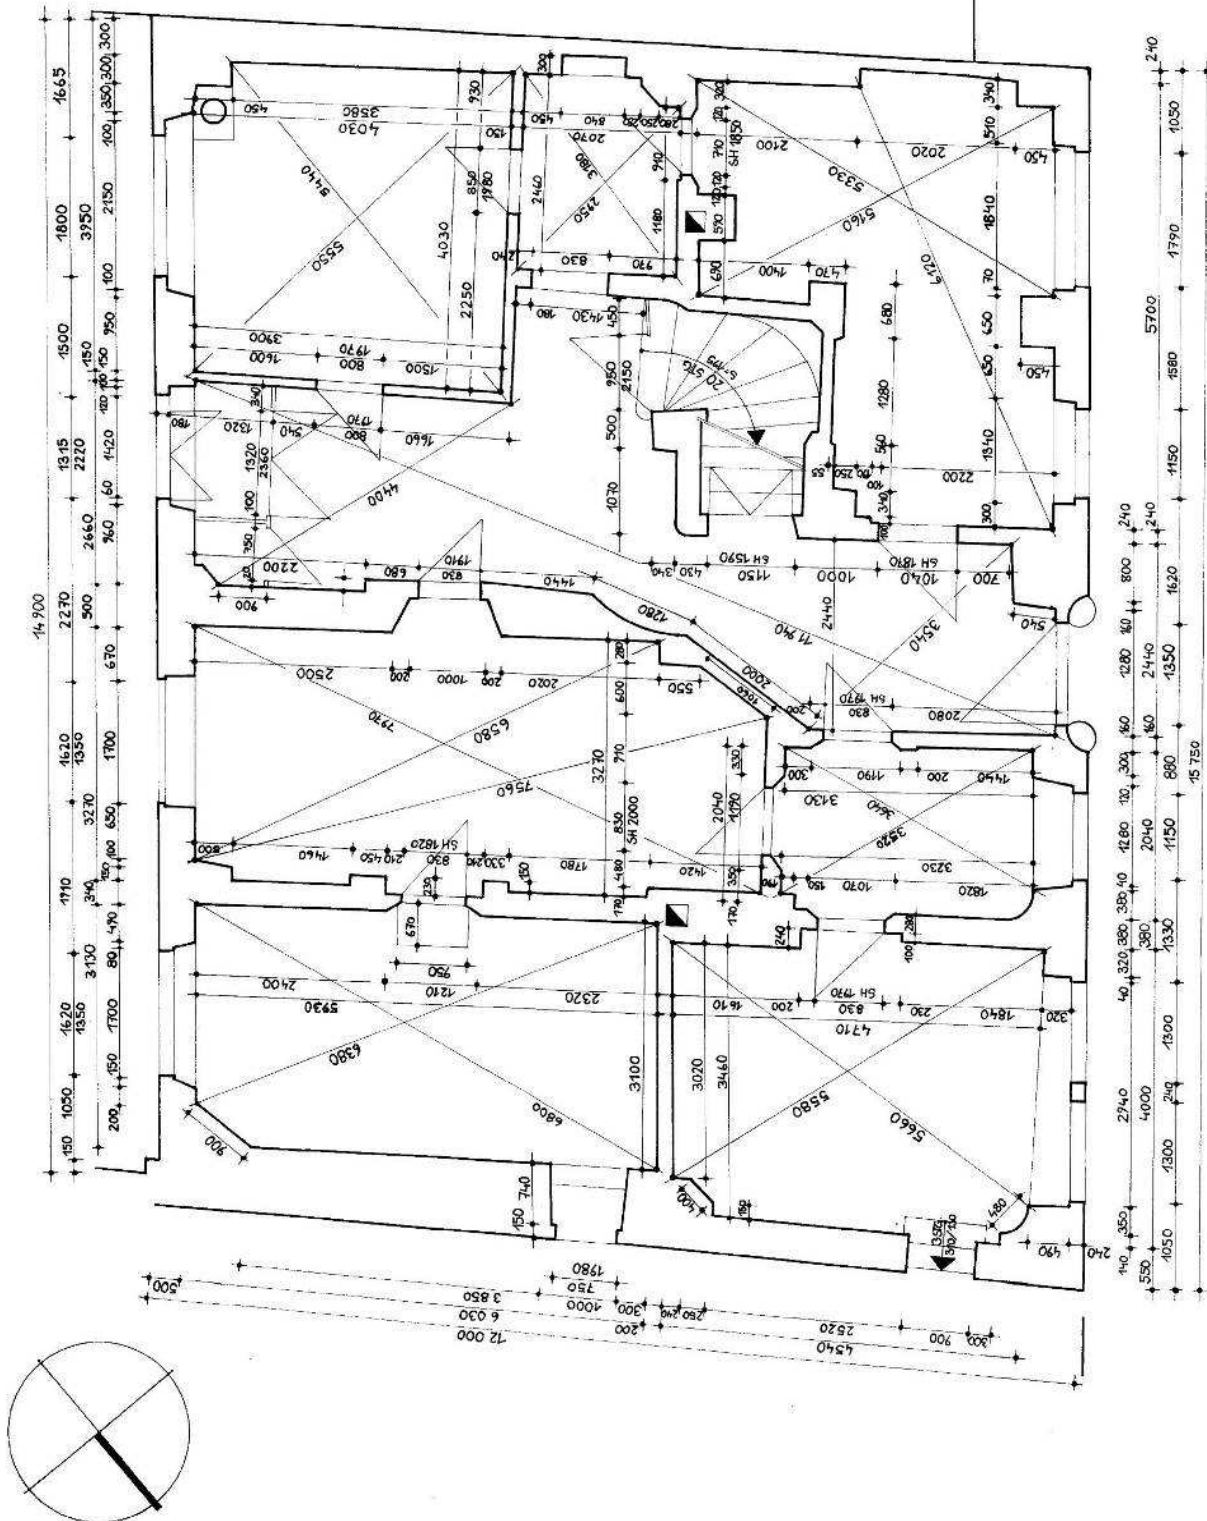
Webergasse 1, Grundriss Erdgeschoss vor der Sanierung
